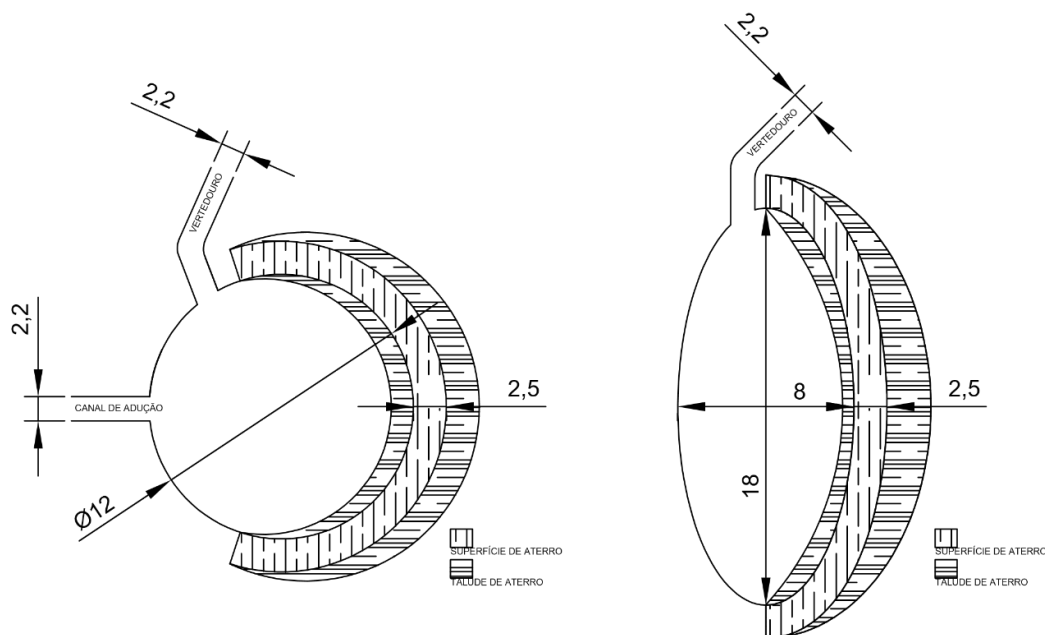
Projeto típico barraginha de 6,0 m de raio interno – vistas superiores – medidas em metros
